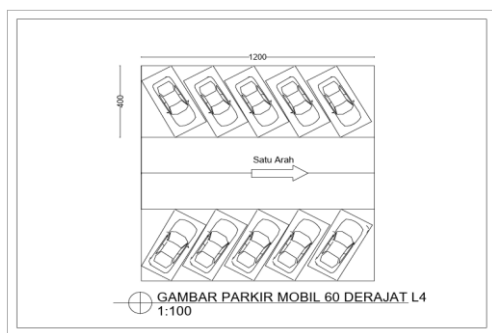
Gambar X. Pola Parkir lantai 2, Parkir Bertingkat
